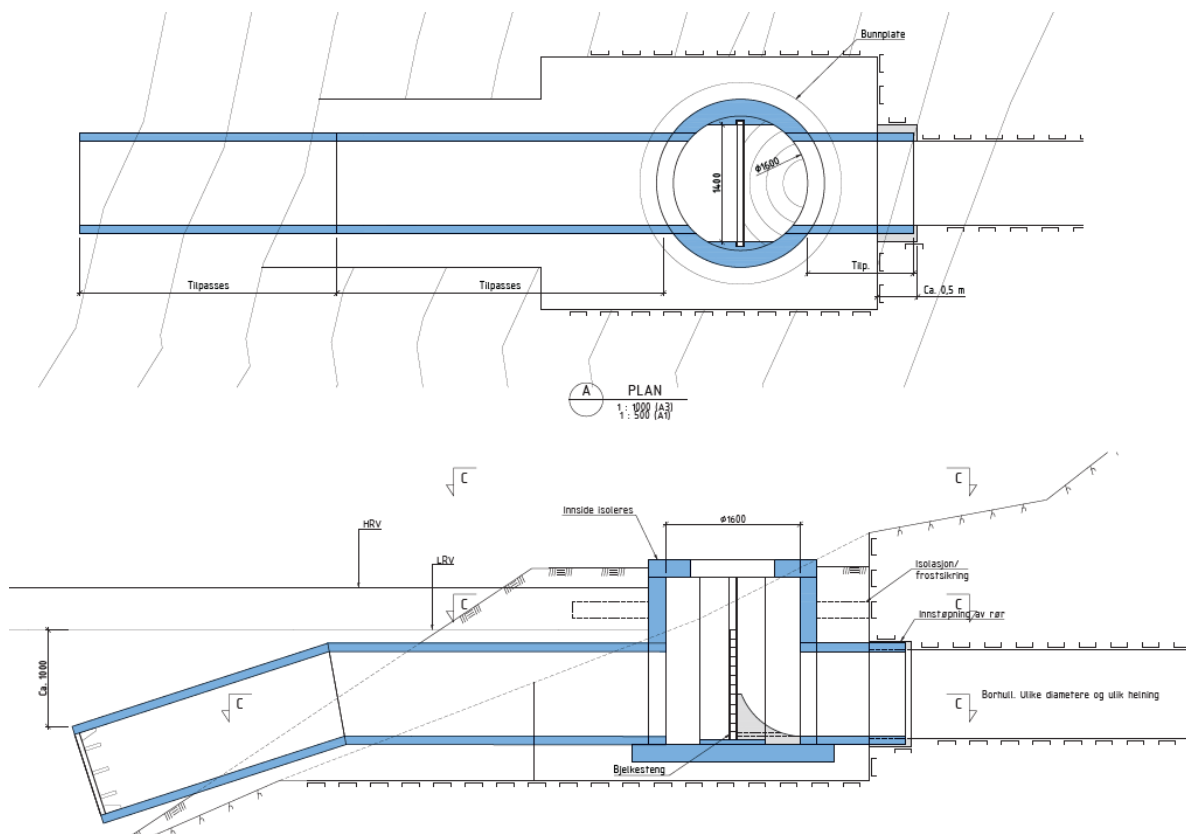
Portalkonstruksjon for adkomst til pumpehallen.
